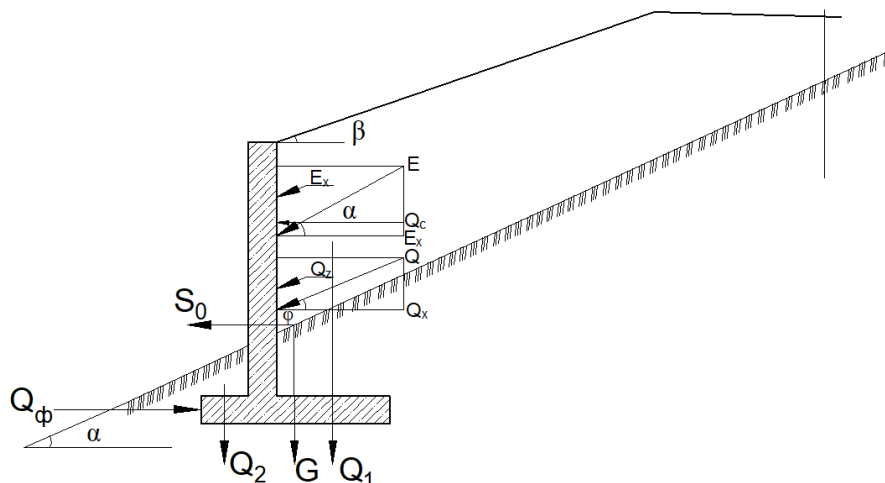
Расчетная схема насыпи на косогоре с подпорной стенкой
